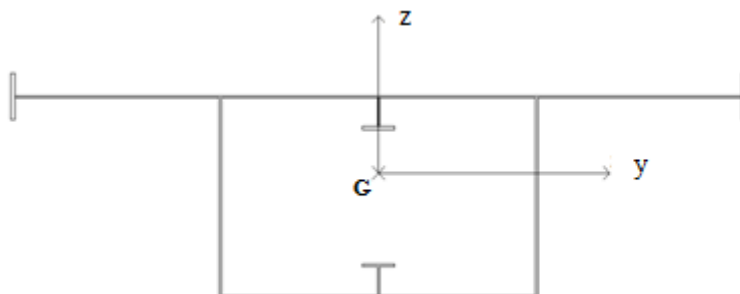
Representação dos eixos da secção transversal da viga caixão.
